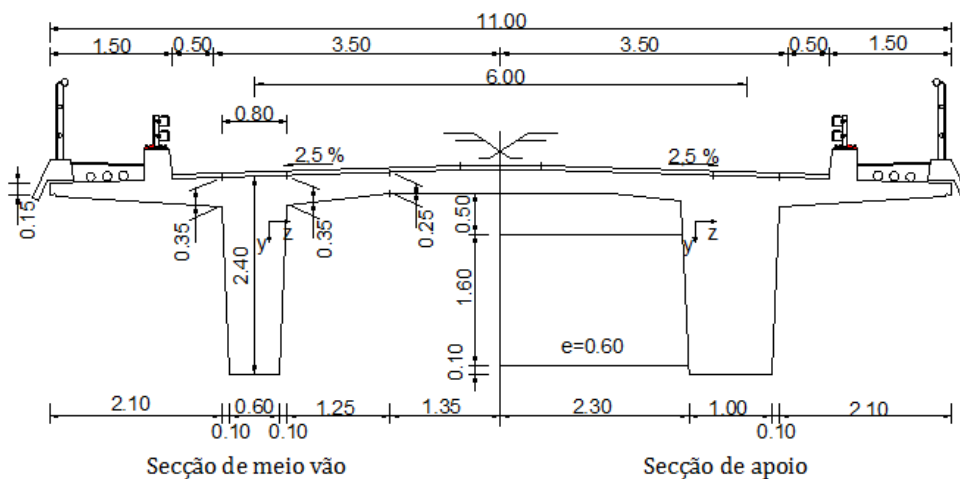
Secção transversal do tabuleiro do caso de estudo 1, na variante com vãos correntes de 40,00 m.
